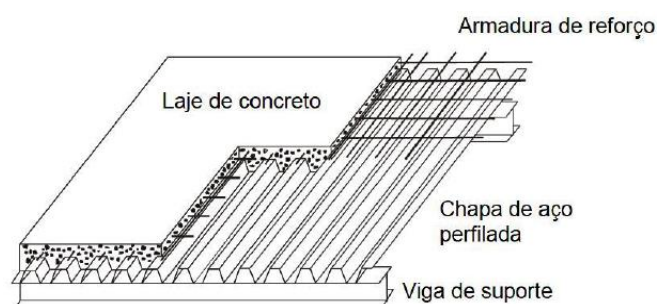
Esquema de uma laje mista corrente (Saúde., Raimundo., Prola., & pierin, 2006)
